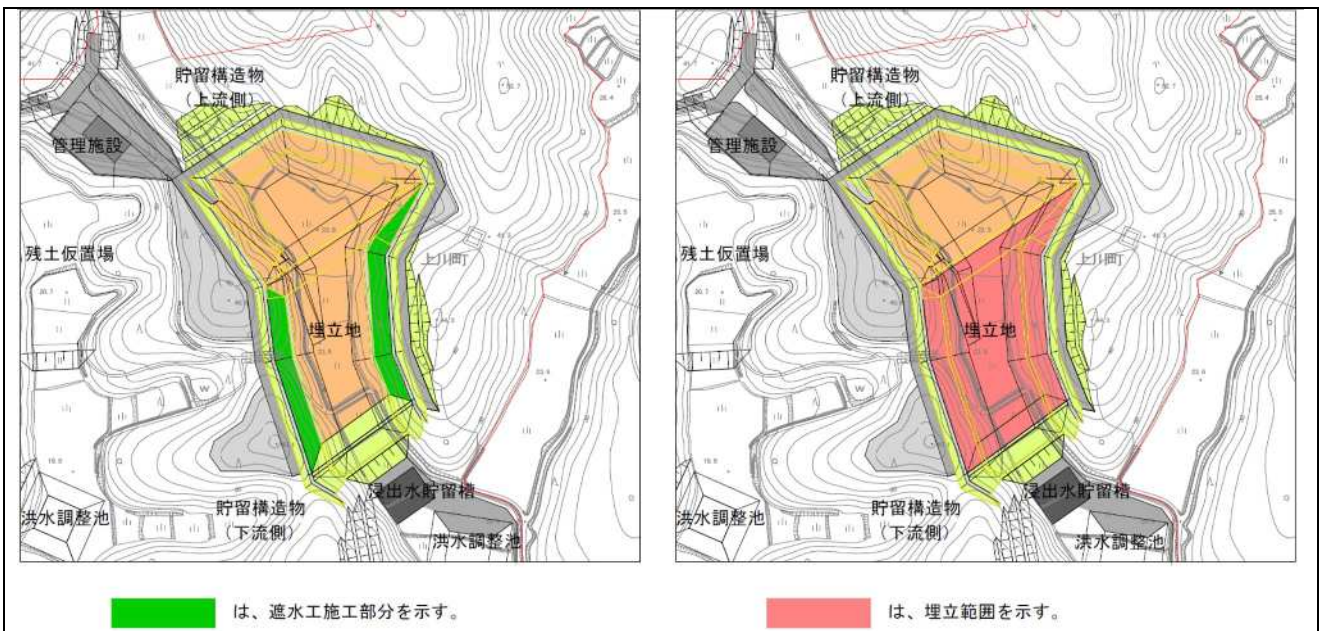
(3) 埋立計画平面図 (第 3 期)
